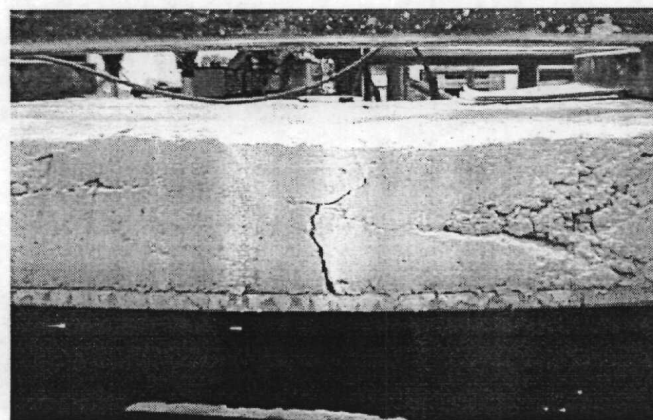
Abertura de grieta en flexión del elemento compuesto
